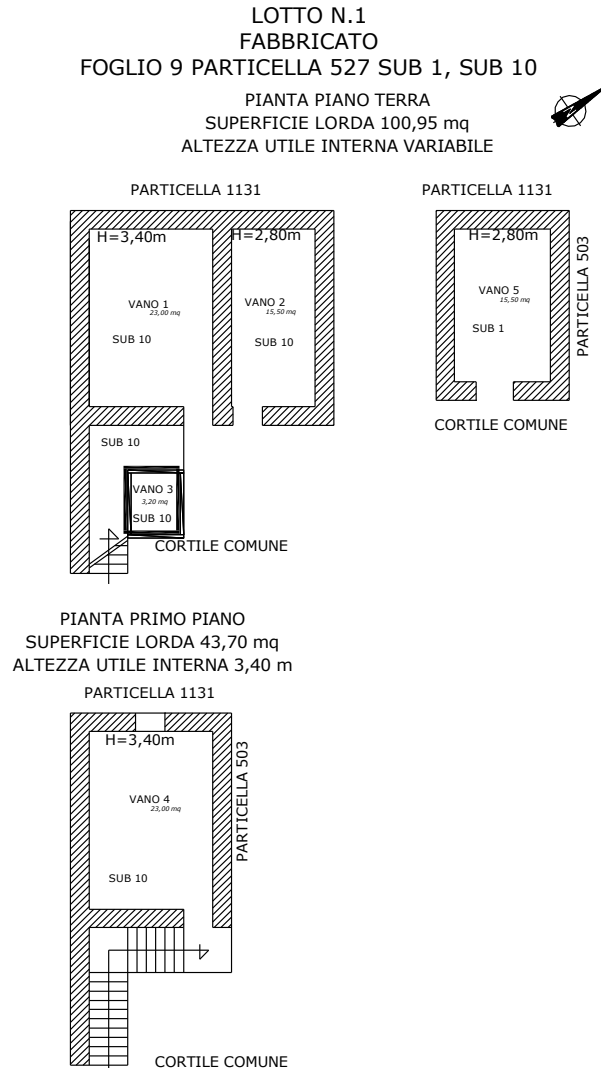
Planimetrie del piano terra e del primo piano del LOTTO N.1
